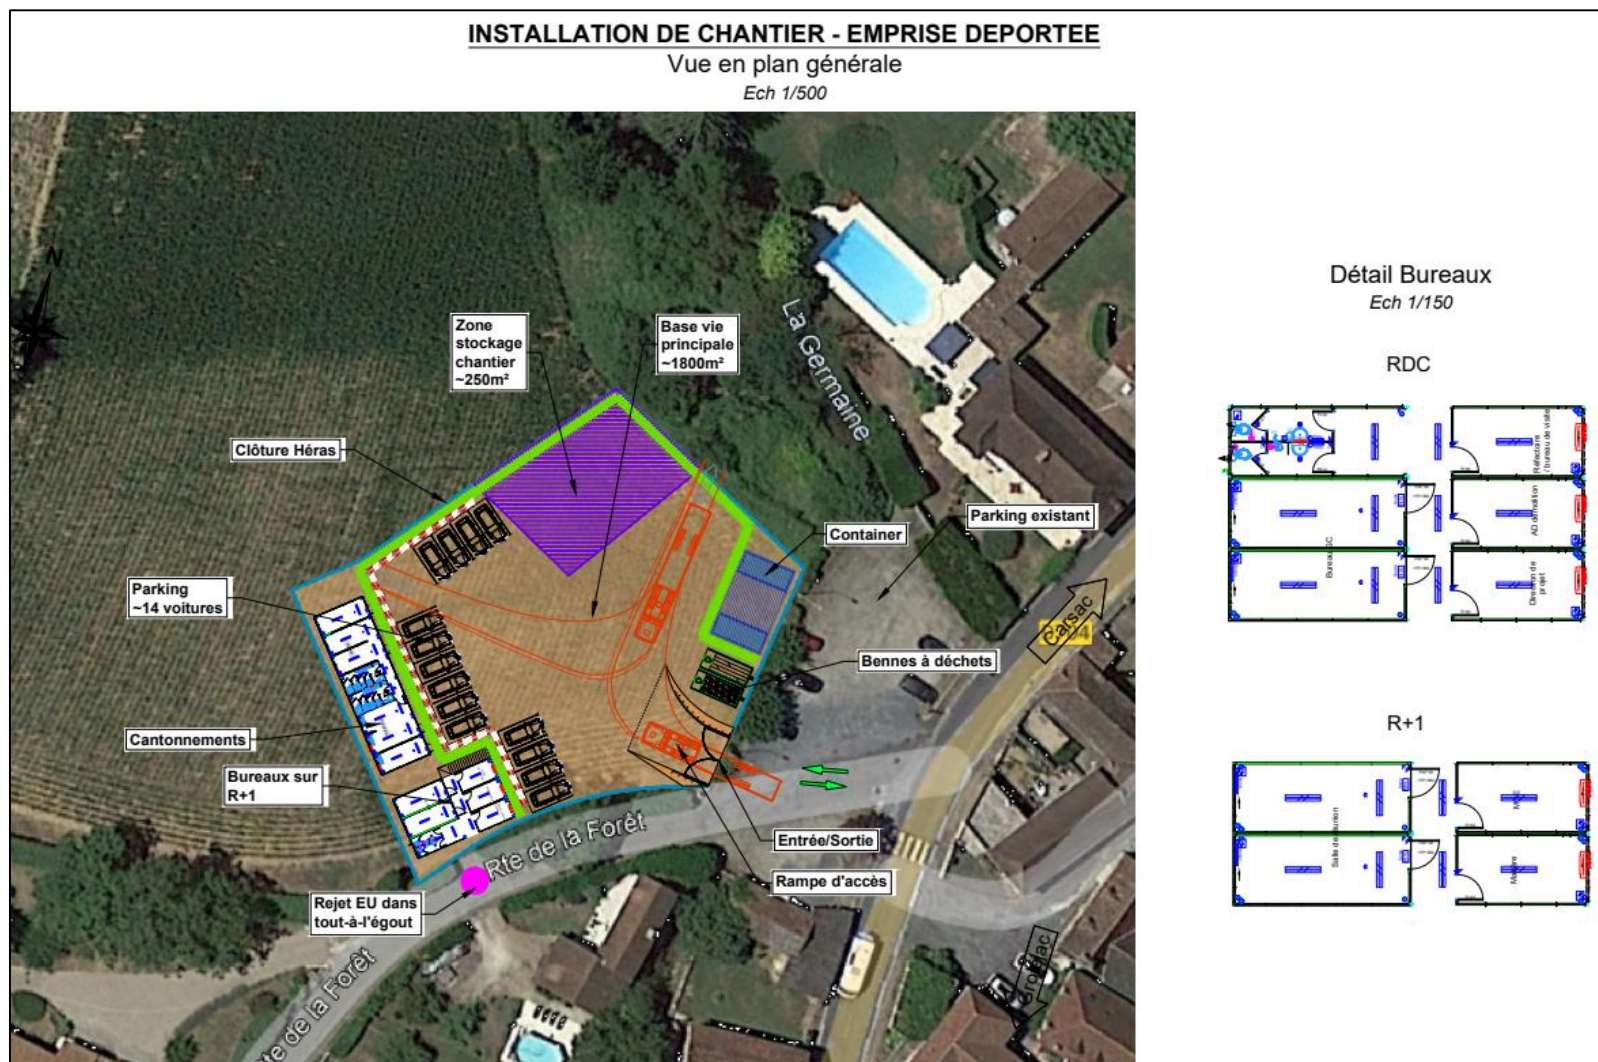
Plan d'installation de la base-vie déportée au sud (Source : NGE)
